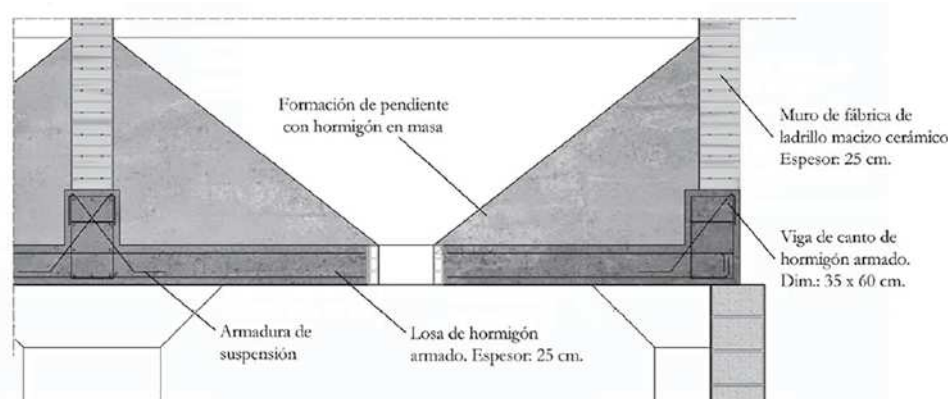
Sección de las bases de los depósitos del silo. Fuente: Planimetría de los autores.
